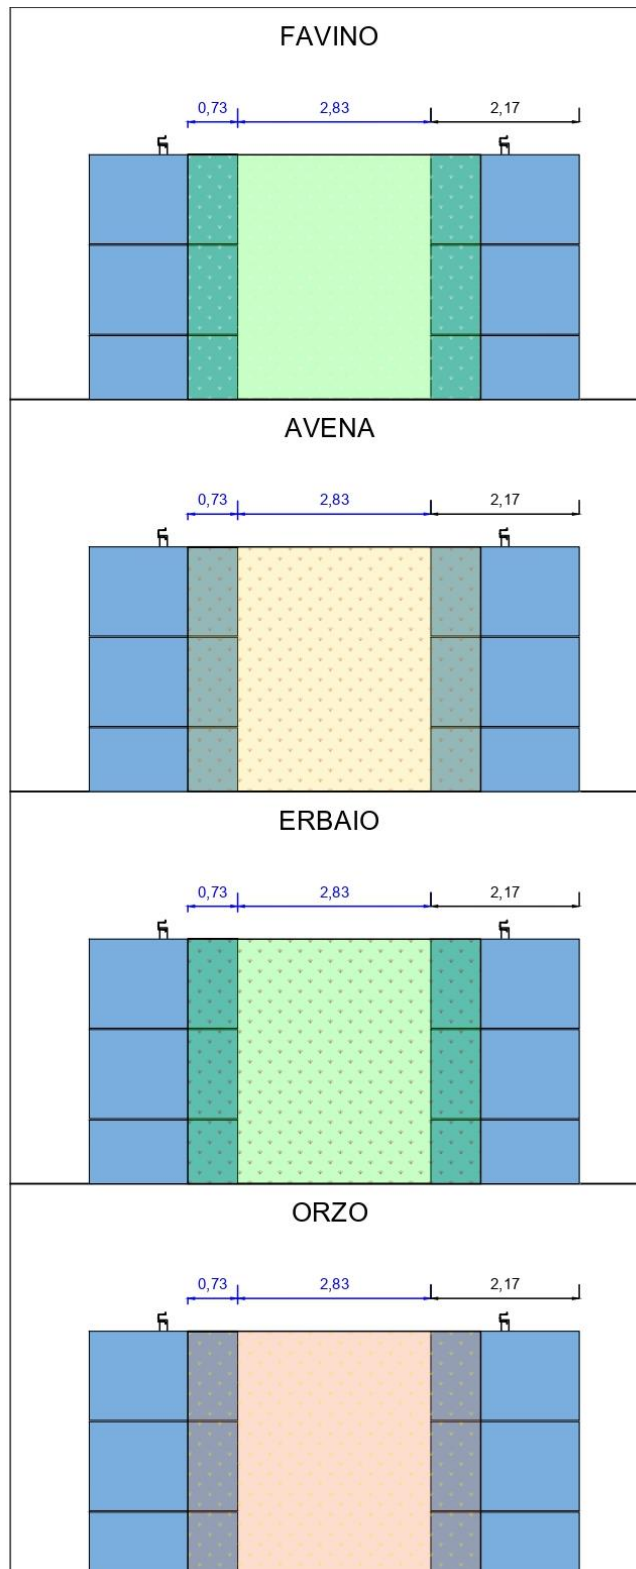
Rappresentazione del prospetto frontale delle colture favino, avena, orzo ed erbaio
